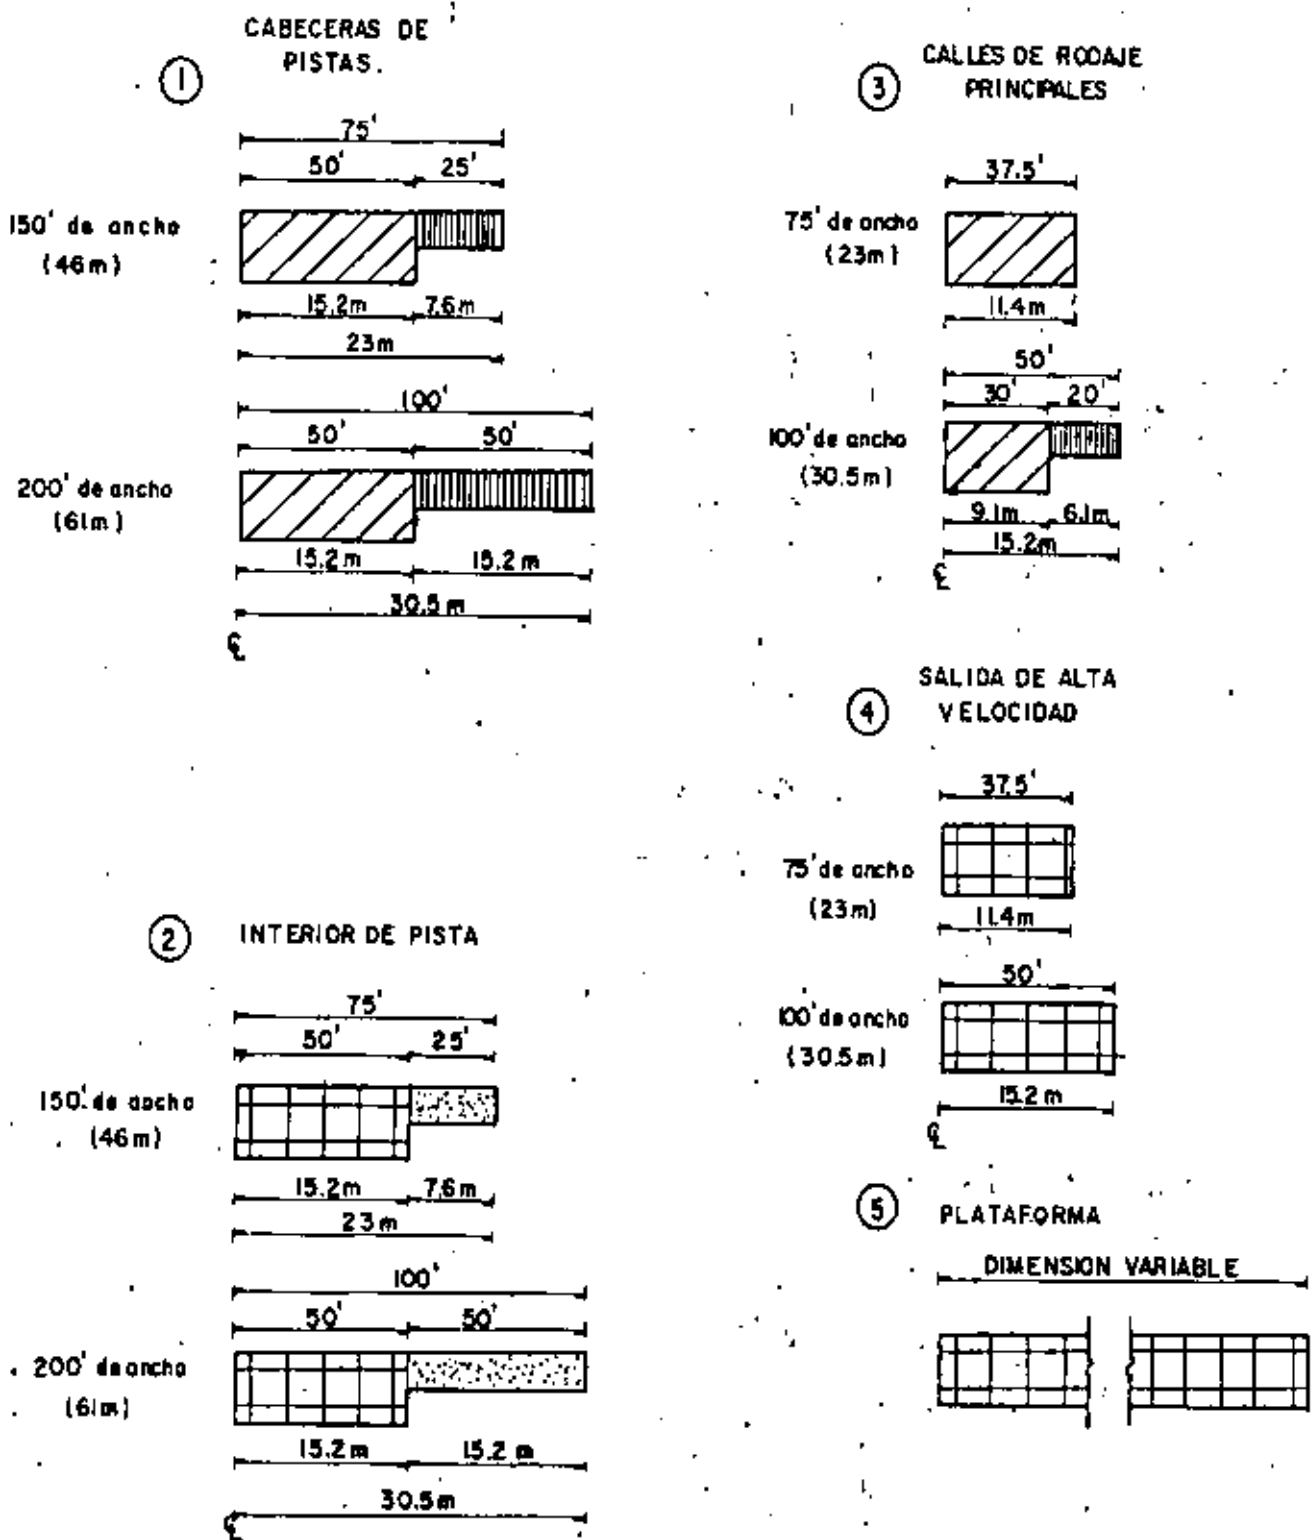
SECCIONES TRANSVERSALES DE PAVIMENTO. Instituto de Asfalto 1973)
